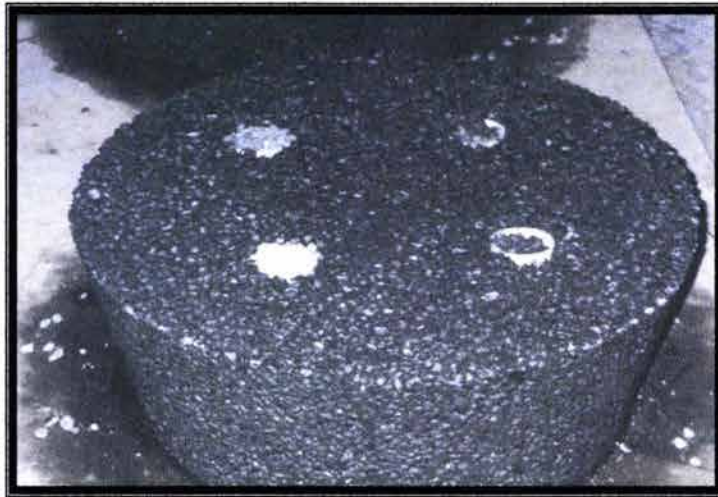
VISTA DE TAPA PARA COLADERA
